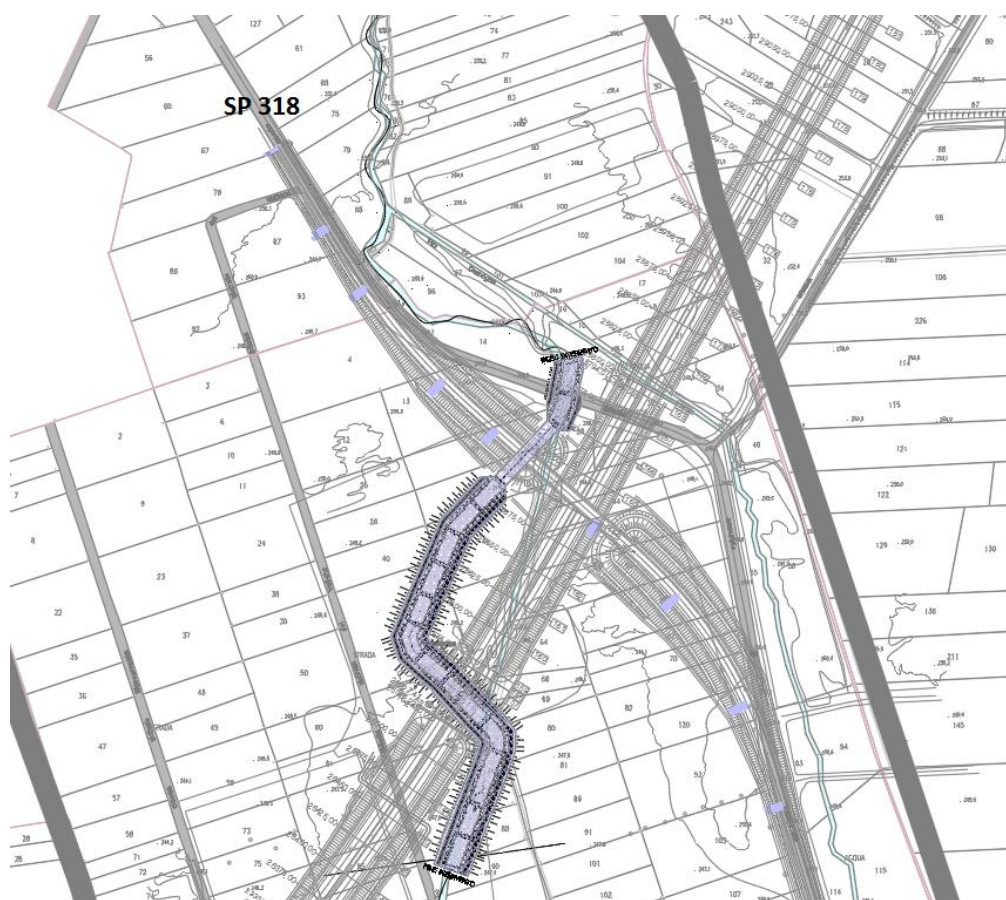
Planimetria della deviazione per il Rio Guarabione
